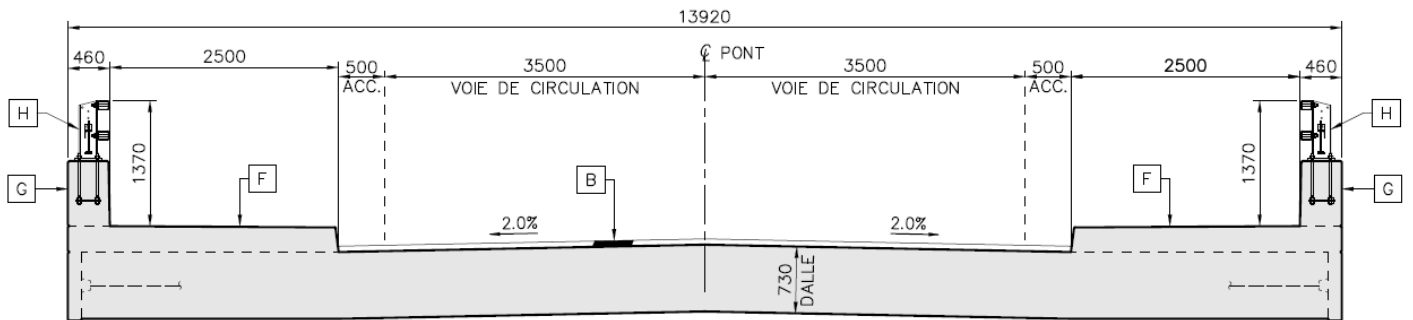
Extrait du plan d'ensemble du scénario 2 – Option dalle épaisse en béton précontraint – Coupe transversale type du tablier proposé
